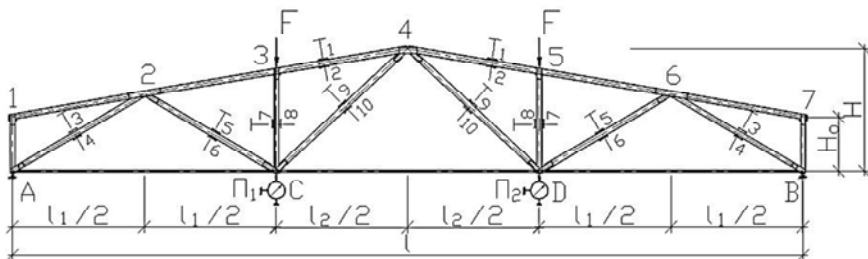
Конструкция, схема нагружения фермы и расстановки приборов:
